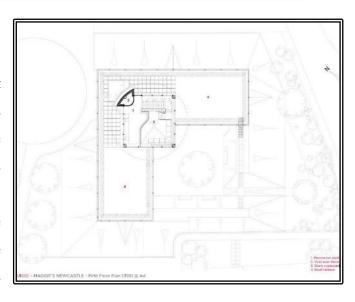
Plan du RDC. Source: https://www.archdaily.com
